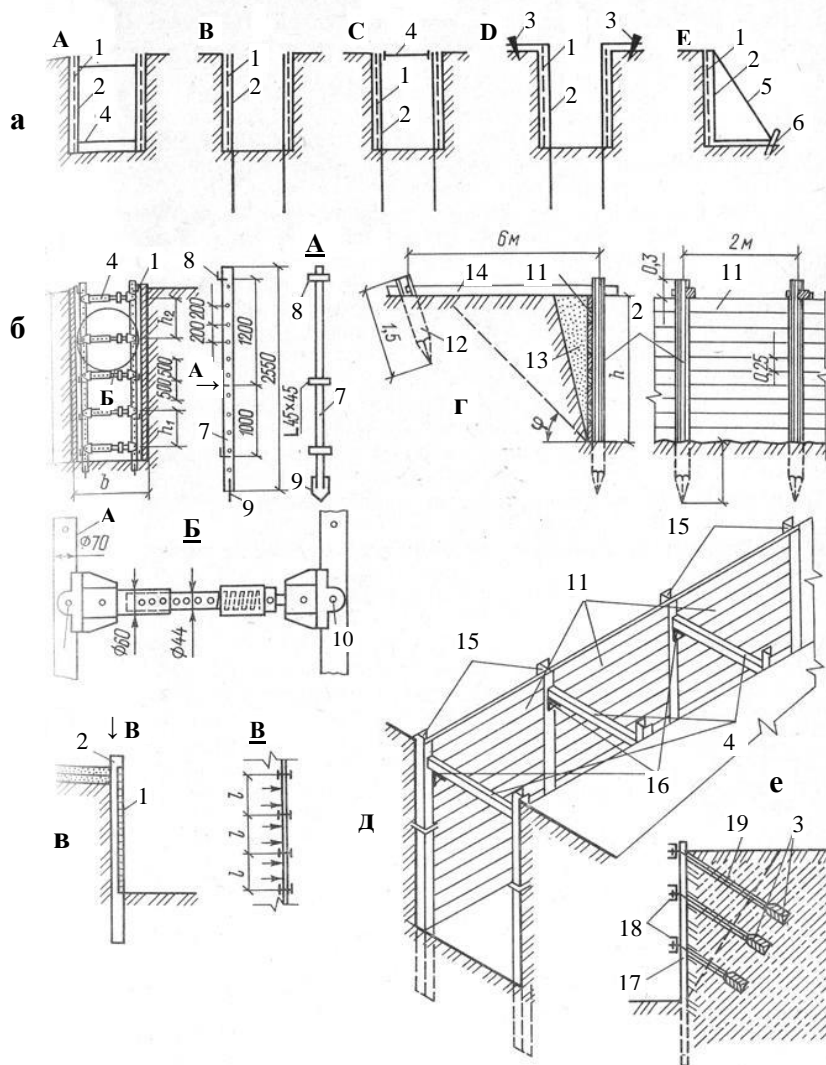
Способи укріплення стінок виїмок: а – схеми конструктивних рішень; б – укріплення інвентарне розпірне; в – консольний тип; г – консольно-анкерний тип; д – консольно-розпірний тип; е – огороження шпунтове з внутрішнім анкерним кріпленням; А – розпірне; В – консольне; С – консольно-розпірне; D – консольно-анкерне; Е – підкосне; 1 – щит; 2 – стояк (паля); 3 – анкер; 4 – розпірка; 5 – підкіс; 6 – уперття; 7 – стояк металевий; 8 – куточок; 9 – загострення; 10 – болт; 11 – закидка; 12 – паля-анкер; 13 – засипання; 14 – тяж; 15 – балка (двотаврв); 16 – куточки сталеві підтримуючі; 17 – стінка шпунтова; 18 – балка (швелер); 19 – тяга
